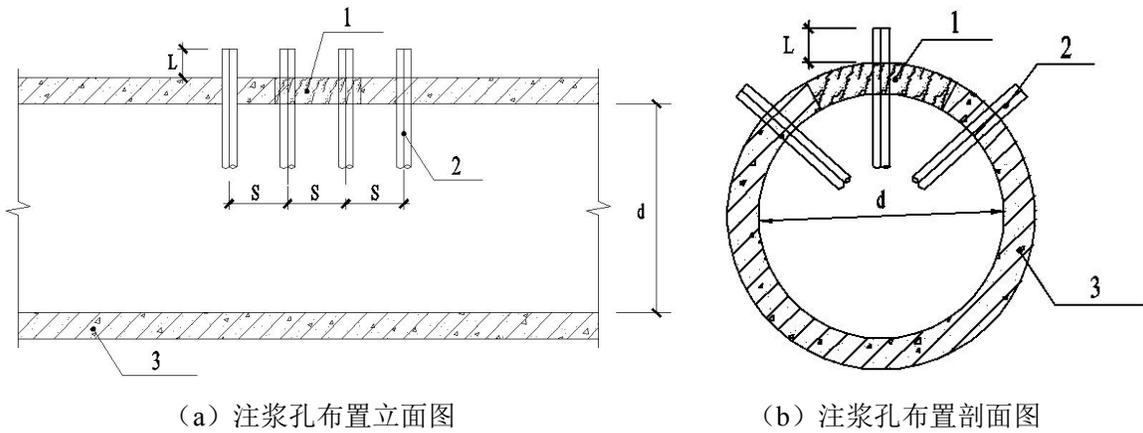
管道周围土加固的注浆孔布置示意图
